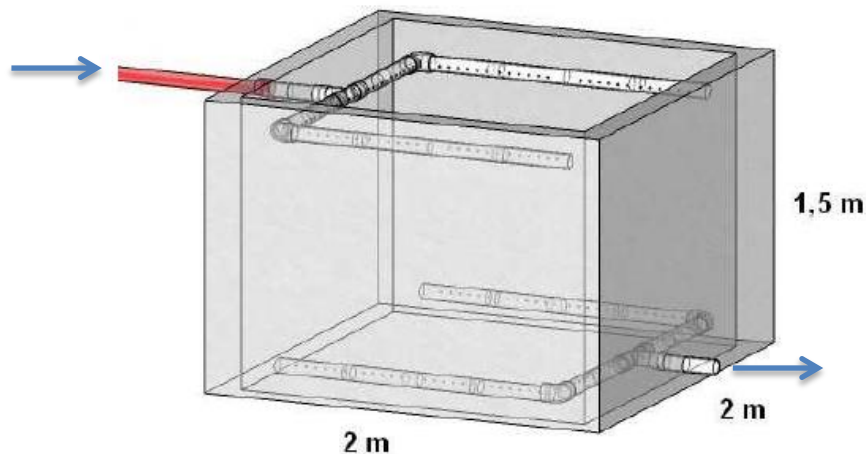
Modelo construtivo de wetlands construídas em escala piloto de fluxo vertical (CANO, 2010)
